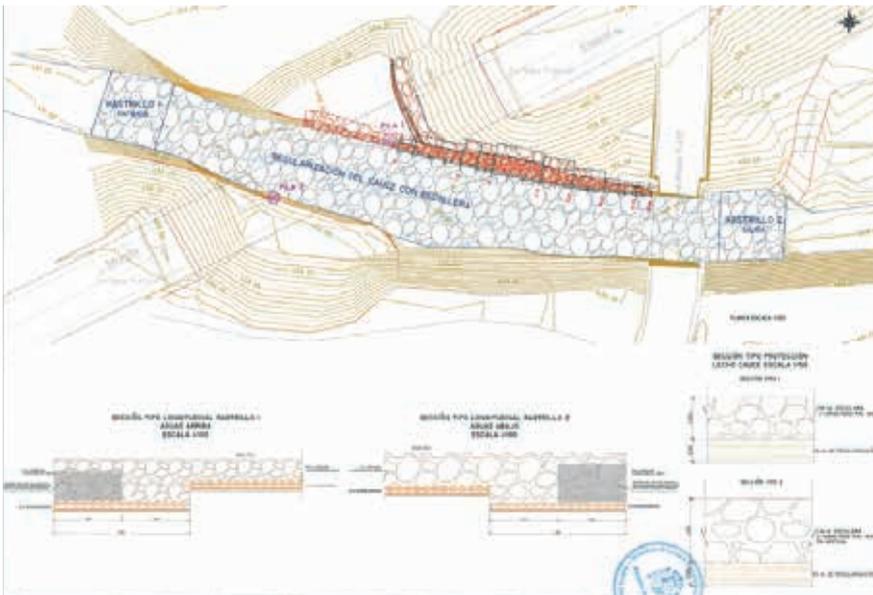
Planta de protección del cauce con lecho de escollera y secciones tipo
